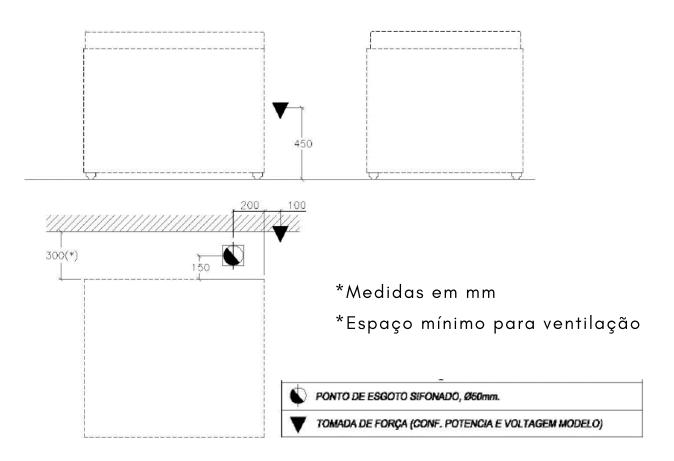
Plantas de pontos de instalação elétrica e hidráulica
